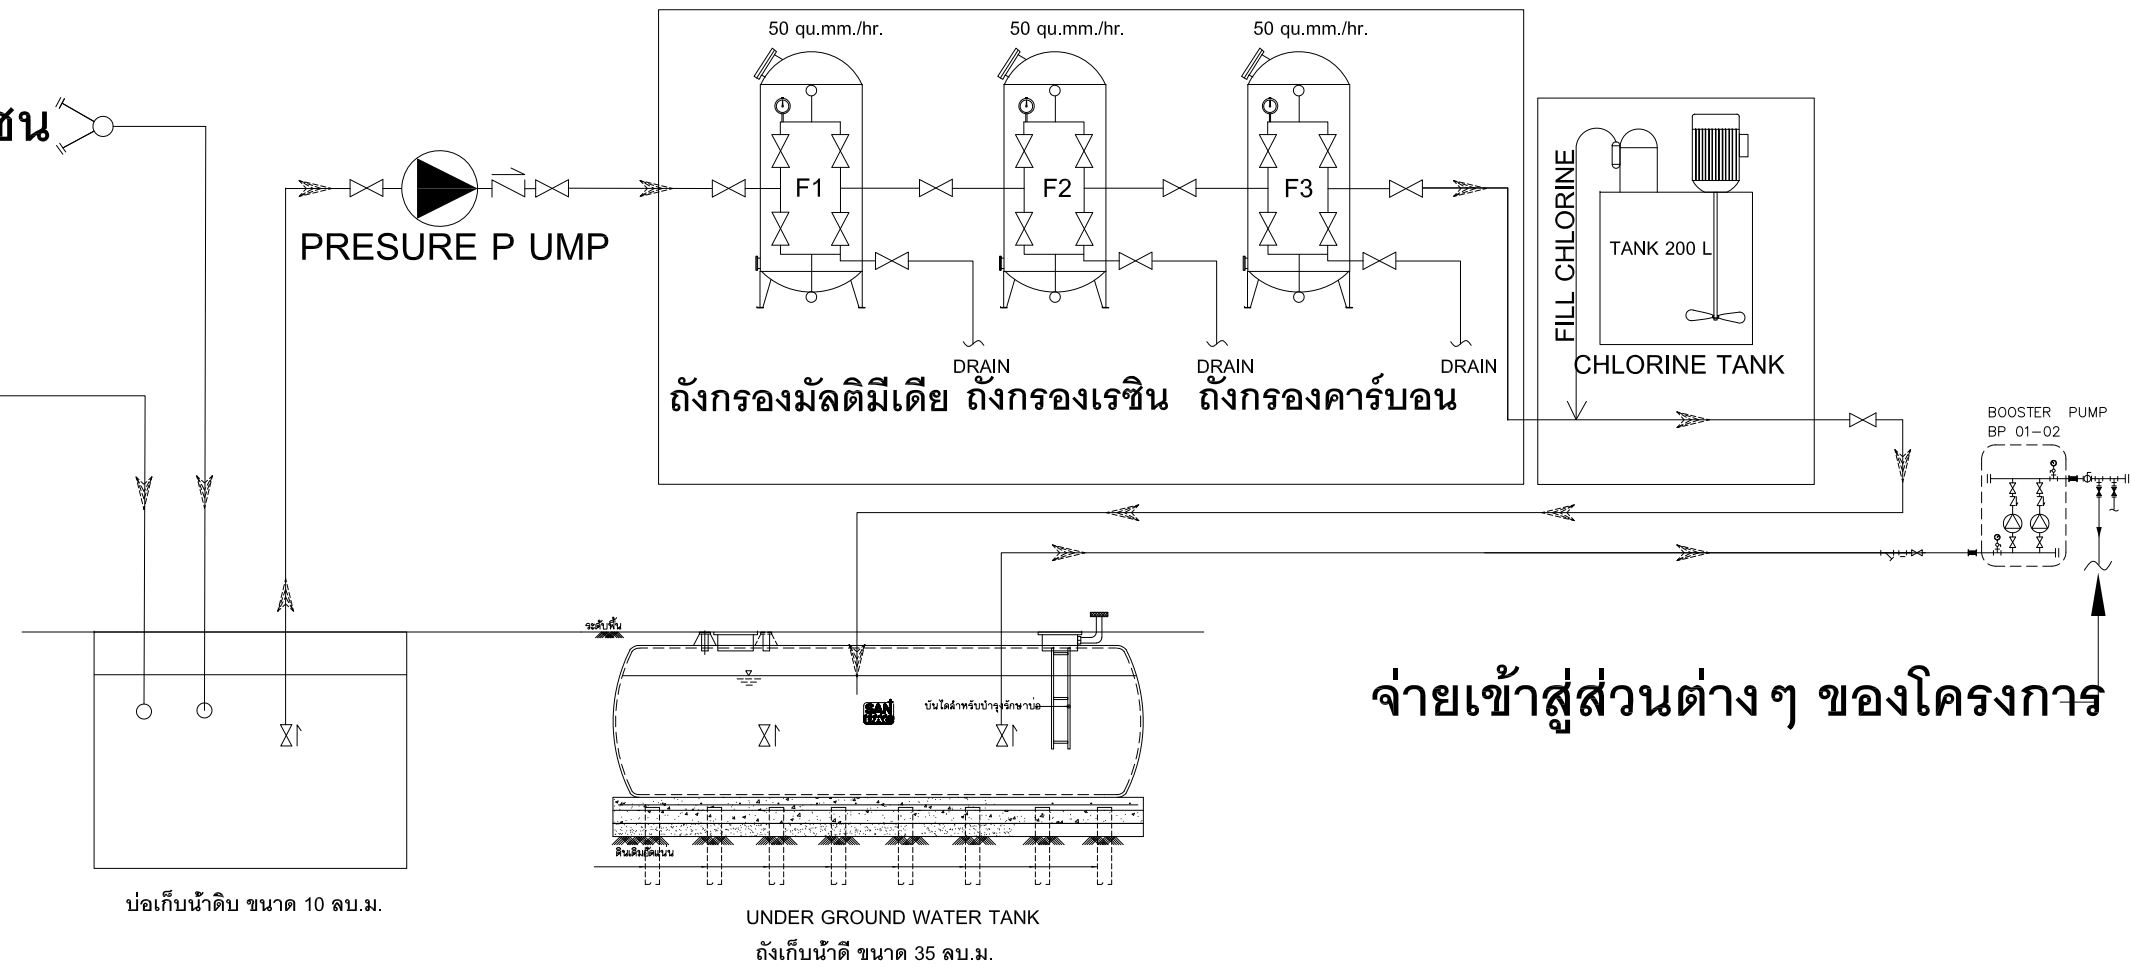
แบบขยายถังเก็บน้ำใช้
